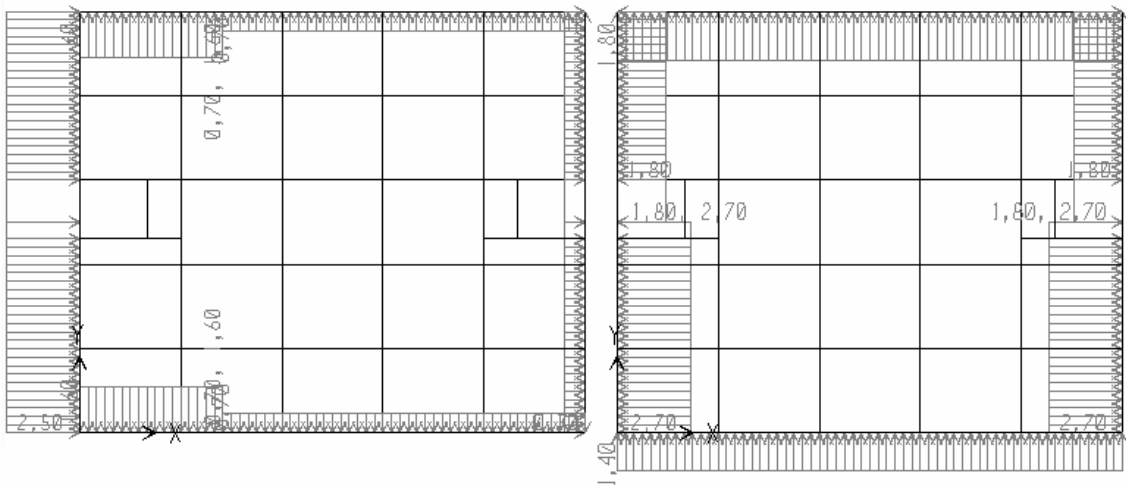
Carregamento de vento do 11º ao 14º pavimento nas direções x e y.
